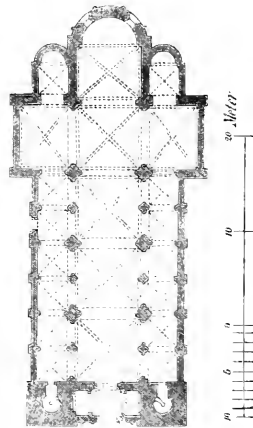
S. Fides zu Schleiffadt. Grundriß.
